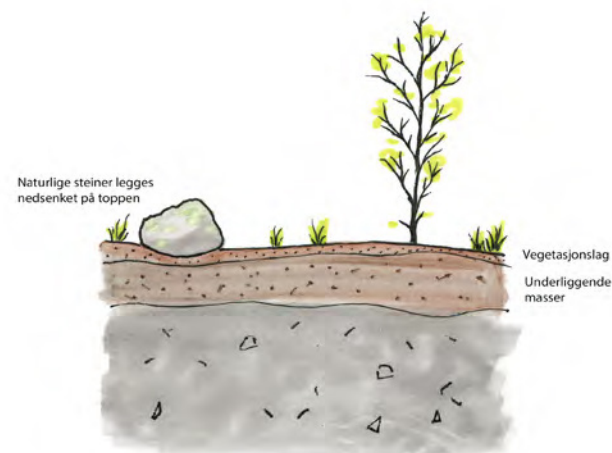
Godt tilbakeført fundament. Overgang mellom fundament og omliggende terreng er ivaretatt på en naturlig måte. Overflaten er rufsete og godt tilrettelagt for naturlig revegetering.
